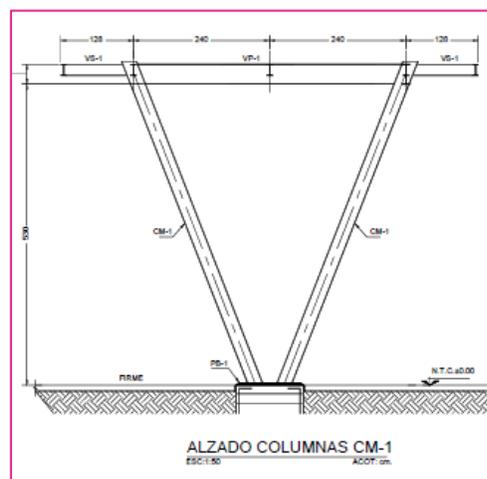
DETALLE DEL PÓRTICO SOSTENIDO EN UN CUBO DE CONCRETO.
